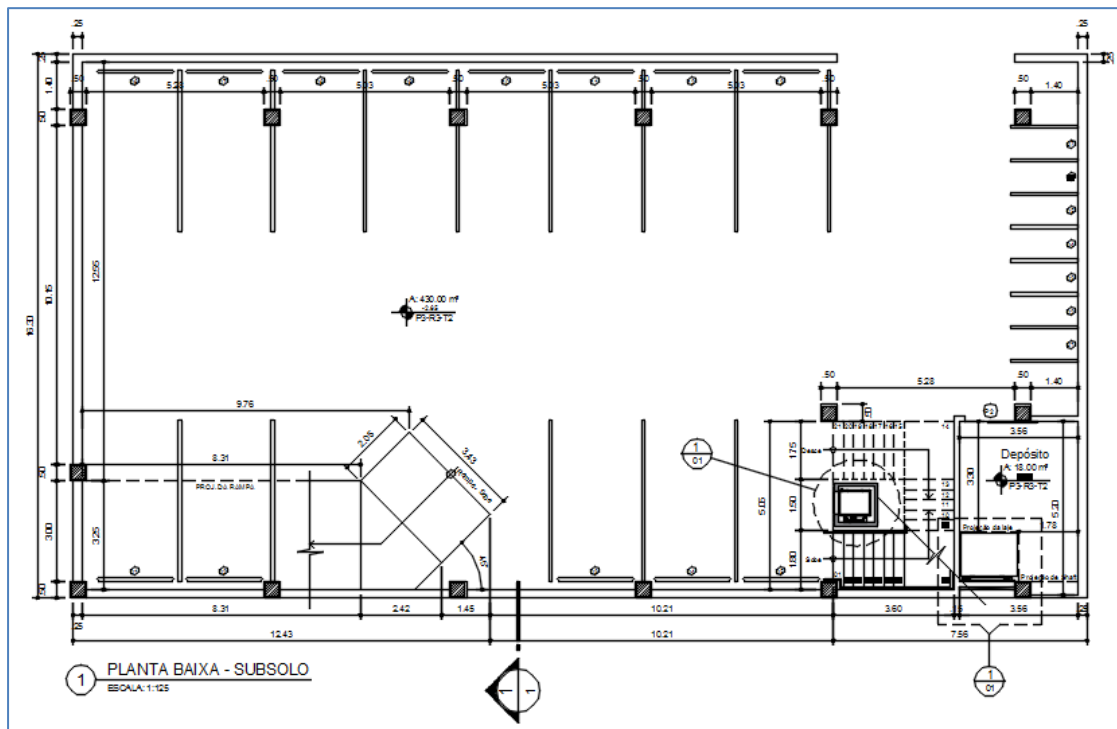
Planta baixa: subsolo (autor do projeto arquitetônico)
